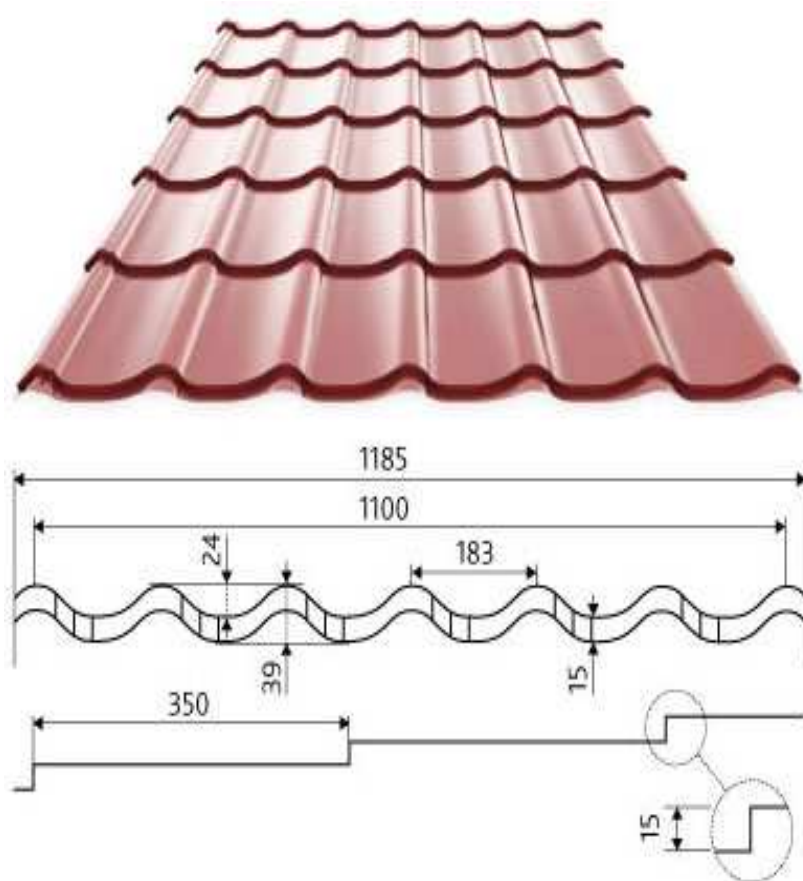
Внешний вид и размеры листа металлочерепицы «Монтеррей»
